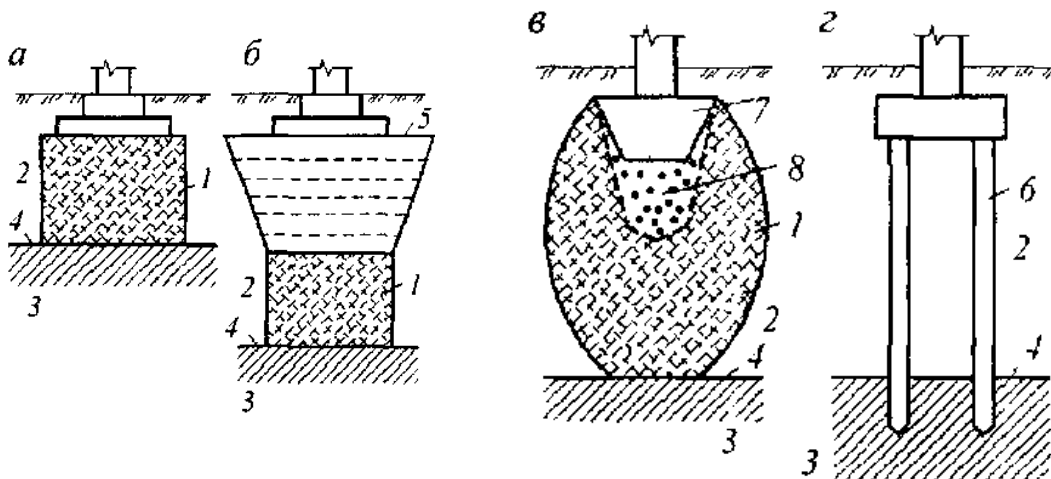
Различные варианты устройства оснований и фундаментов в грунтовых условиях I типа просадочности: 1 - уплотненный грунт; 2 - просадочный грунт; 3 - непросадочный грунт; 4 - нижняя граница просадочного грунта; 5 - грунтовая подушка, уплотненная послойно; 6 - сваи; 7 - набивной или забивной фундамент, пирамидальная короткая свая; 8 - щебень, втрамбованный в грунт
